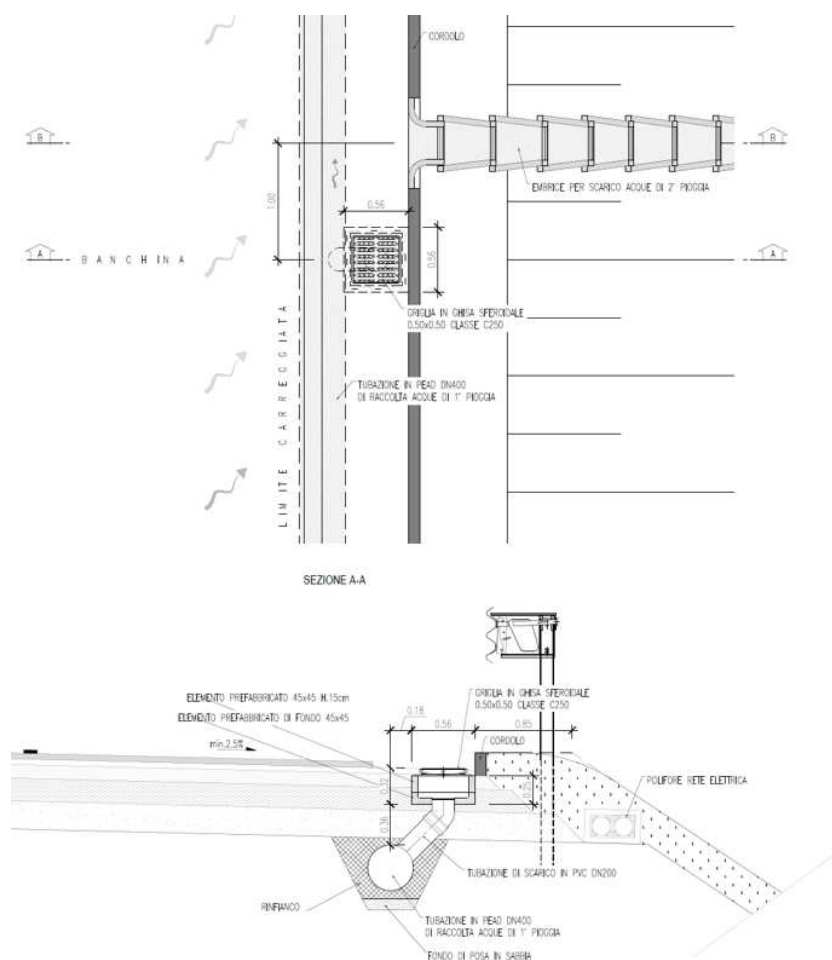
Sistema di drenaggio delle acque meteoriche di prima e seconda pioggia per i tratti di viabilità in rilevato - Pianta e sezione
